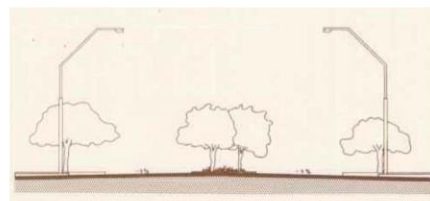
Desenho e fotos de vias estruturais em Ouro Branco
